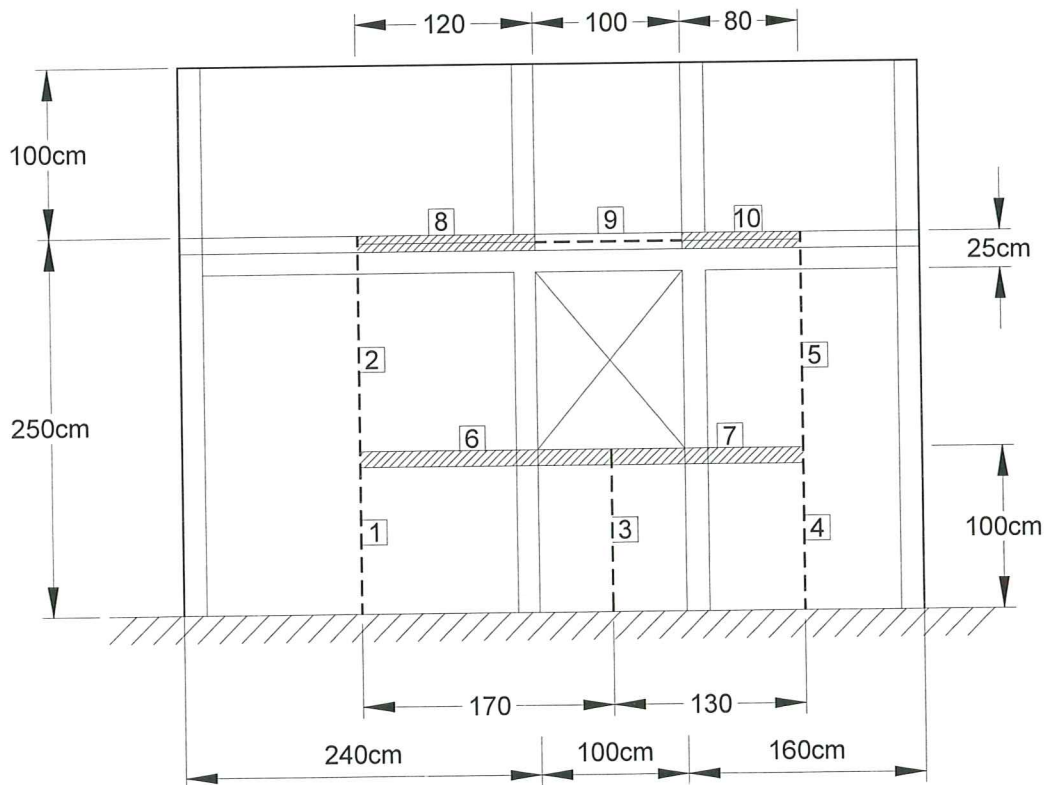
Modelo de columna ancha para el espécimen WW.
